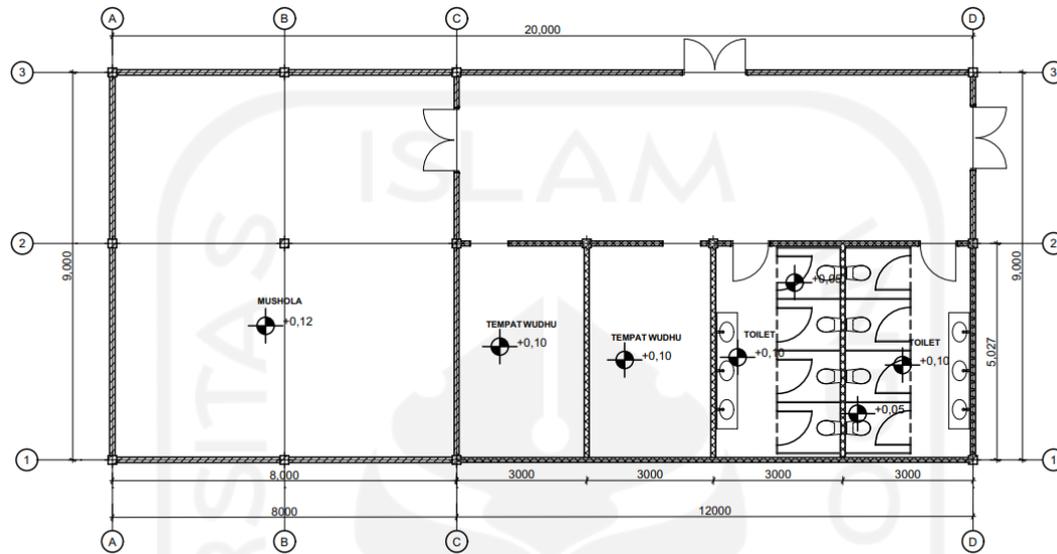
Denah Lantai 1 Bangunan Workshop Setelah Revisi
